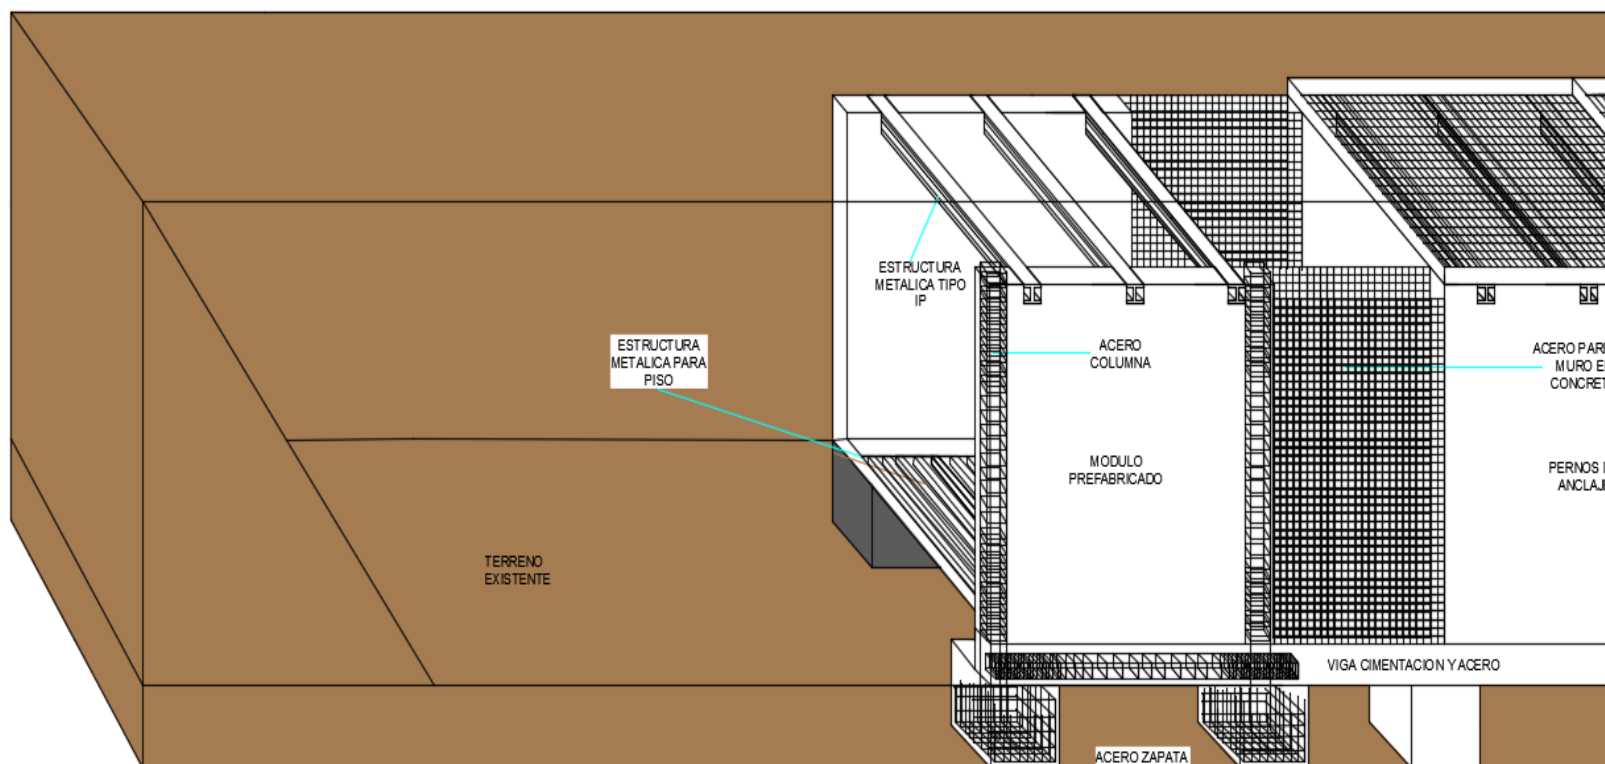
Detalle Sistema Prefabricado E Instalación Estructura Metálica Propuesto
